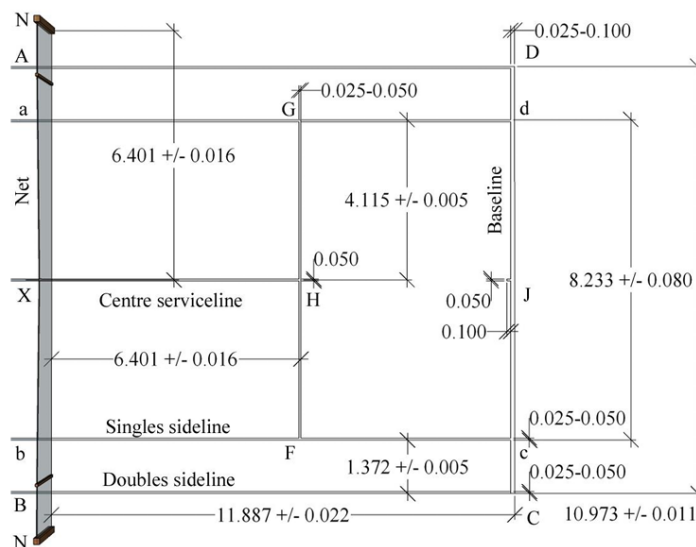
Planta de meio court e respetivas dimensões (em metros)
